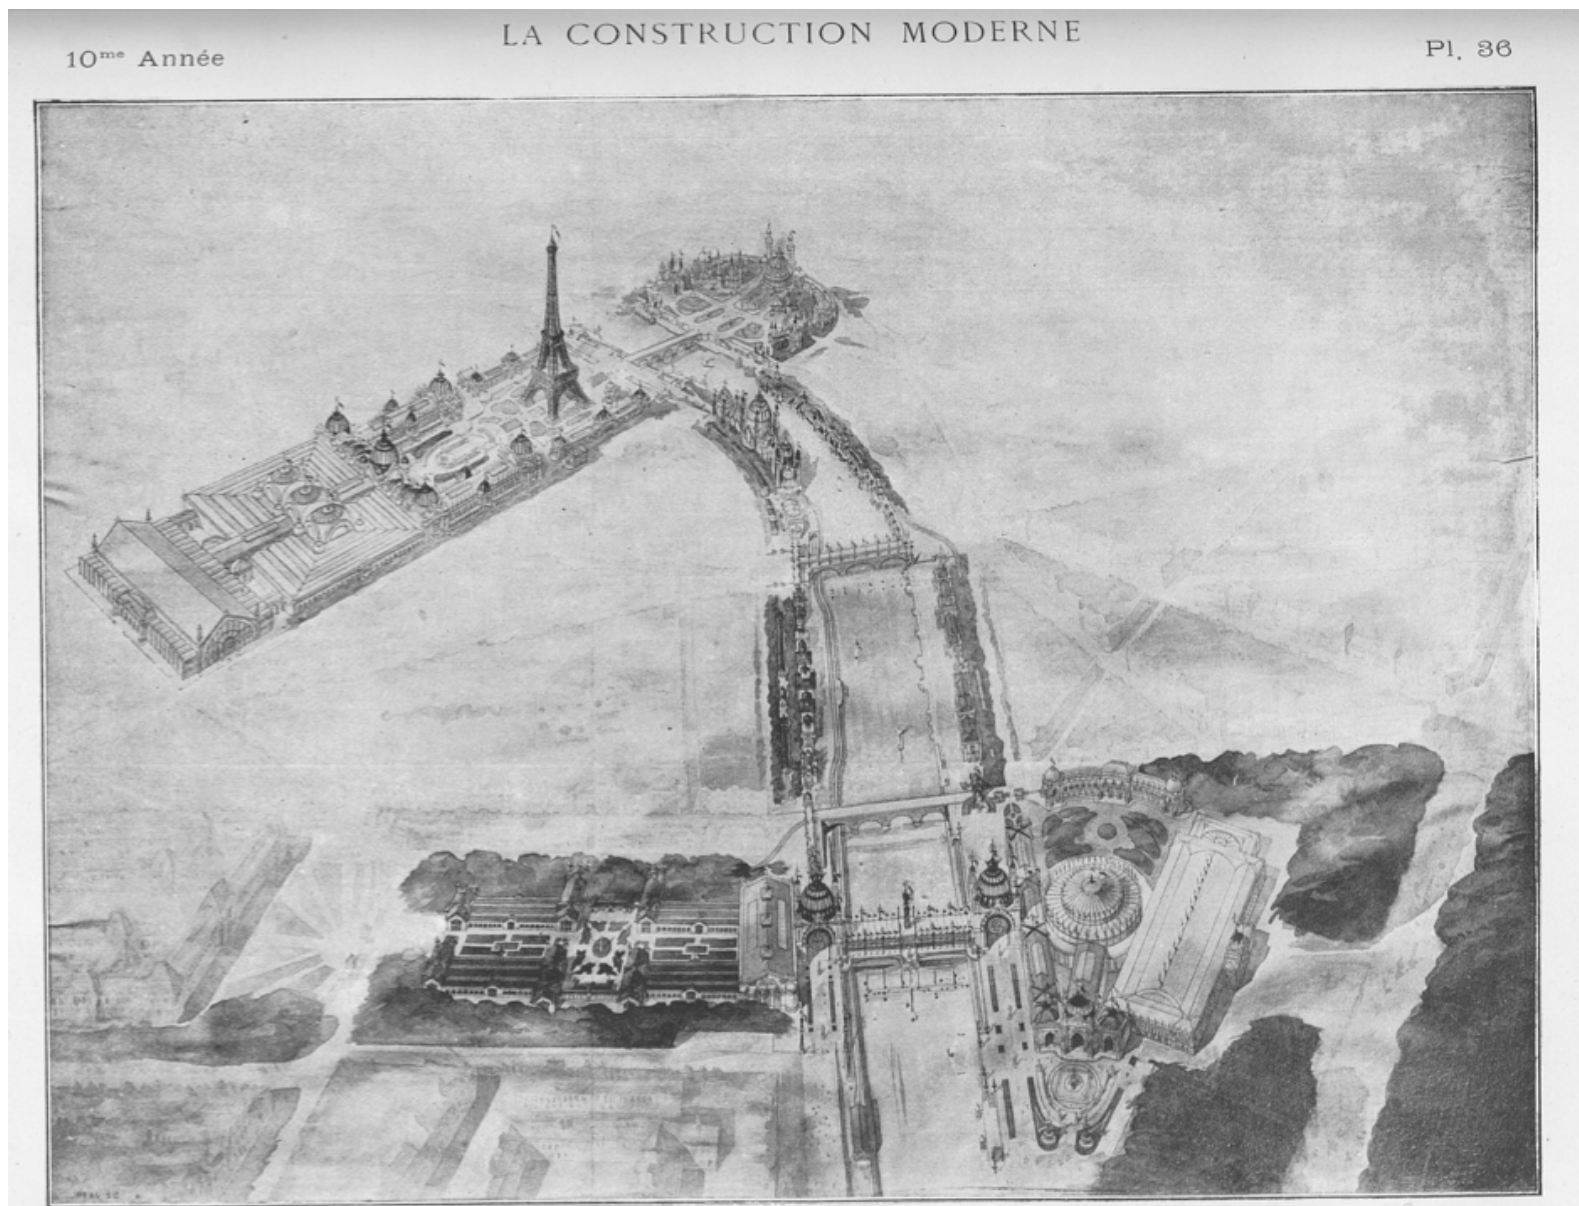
Exposition Universelle de 1900. 1er Prime: M. Paulin.. (Fonte: La Construction Moderne, CM-1895-01-RAPPORT DE M. GUADET [cont.], 1895)
